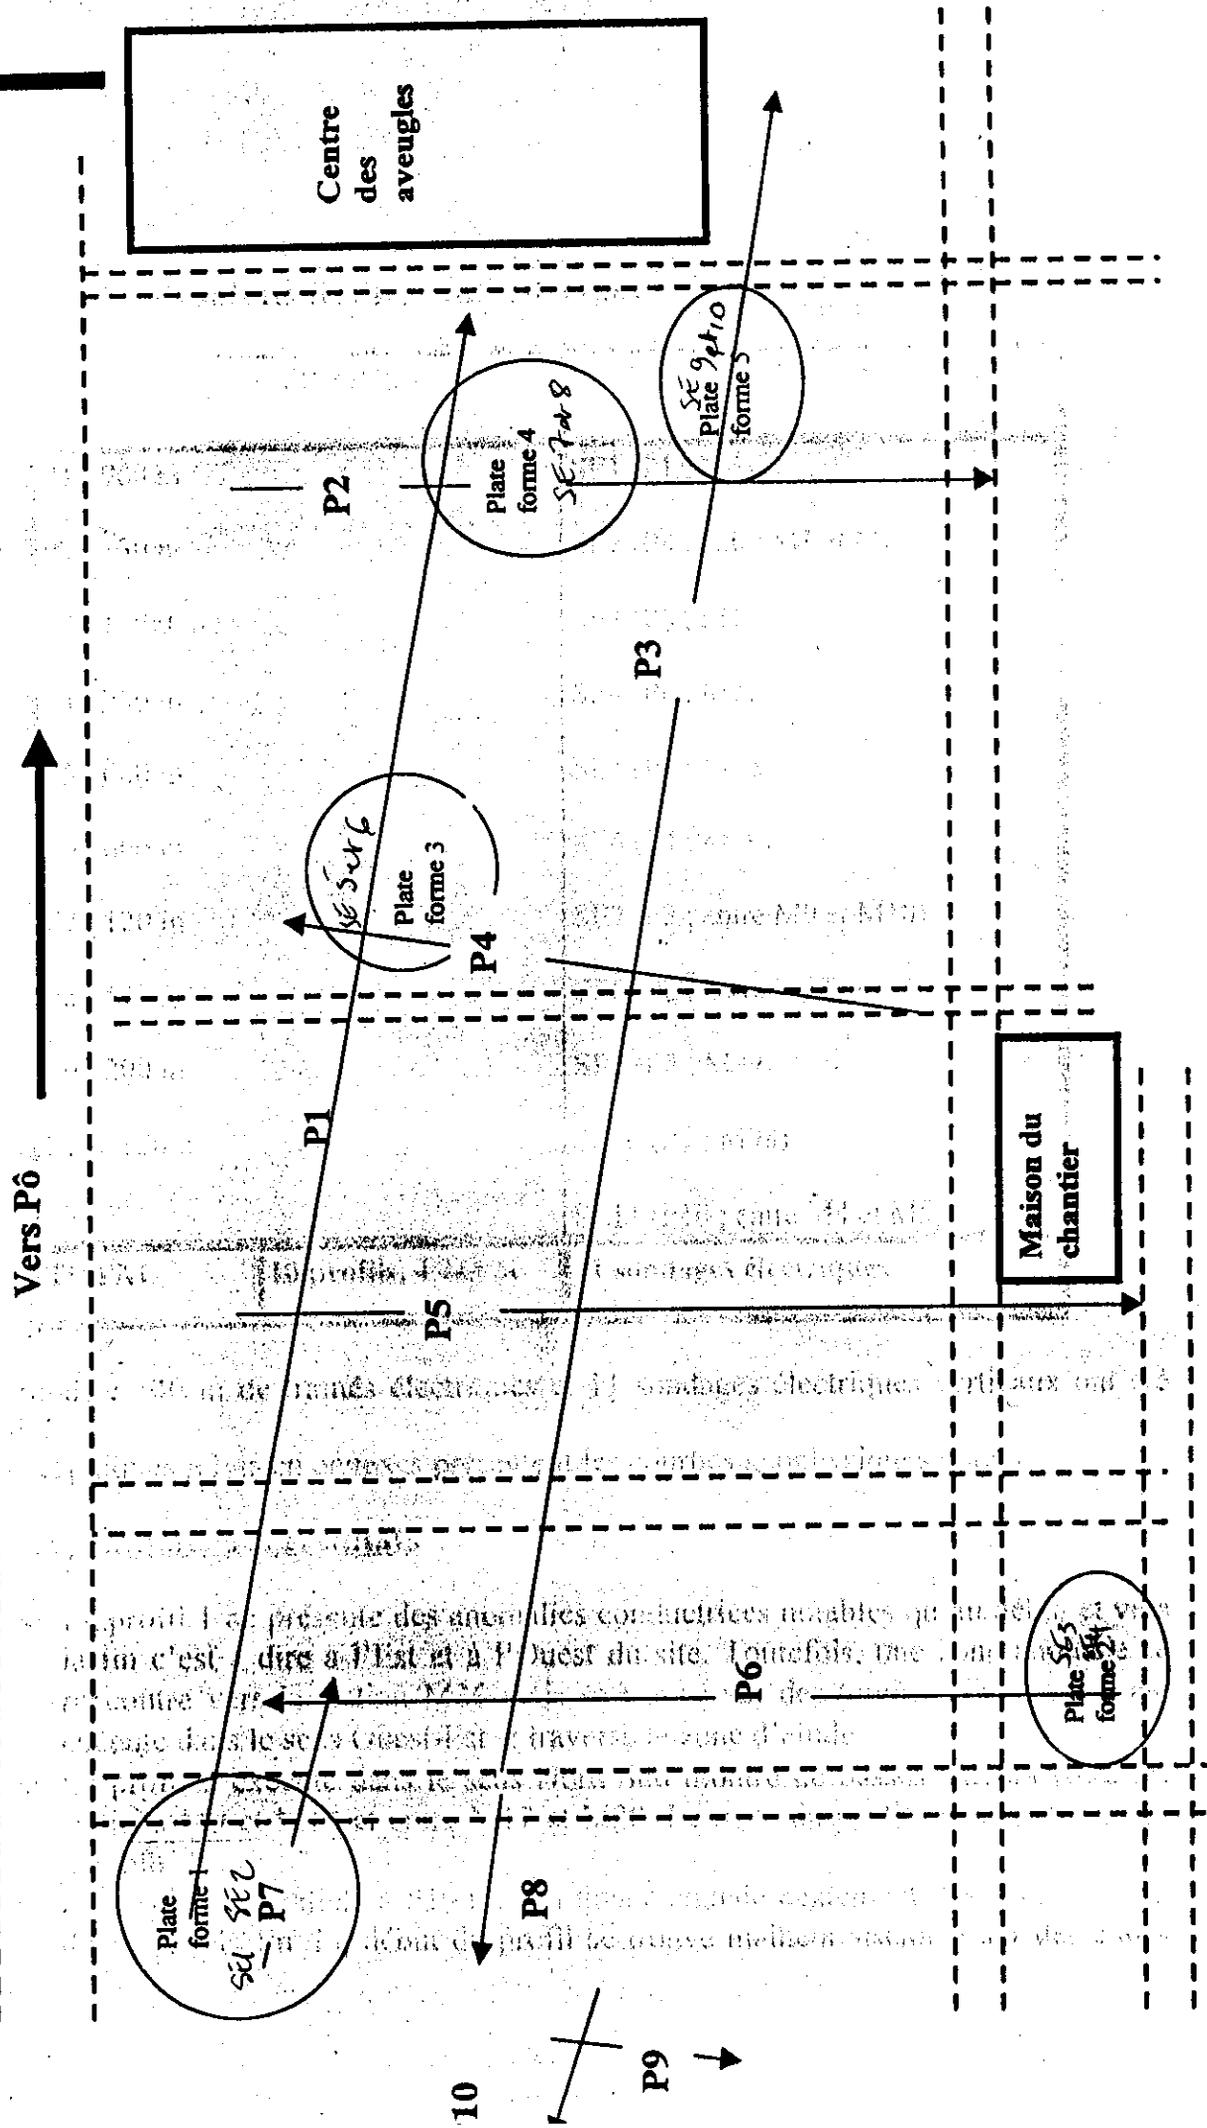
PLAN DE SITUATION DES PROFILS ET DES PLATE-FORMES DE LA TRAME D'ACCEUIL (ZACA)
